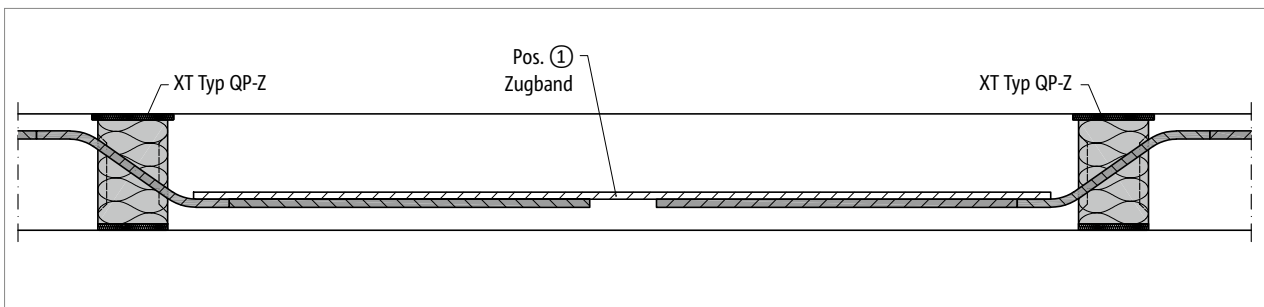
Schöck Isokorb® XT Typ QP-Z, QP-Z: Schnitt A-A; Bewehrungsanschluss Zugband
